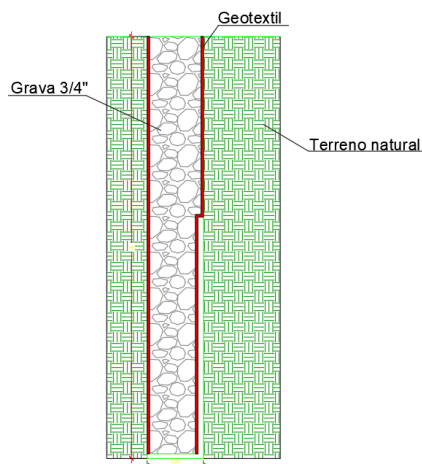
Detalle típico de las trincheras drenantes (Grava + Geotextil)
